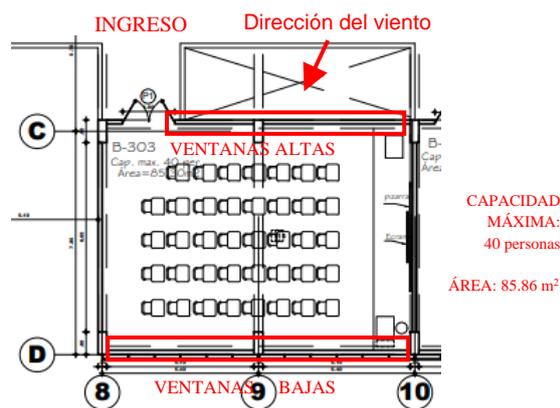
Pabellón B Facultad de Ingeniería Aula B-303
